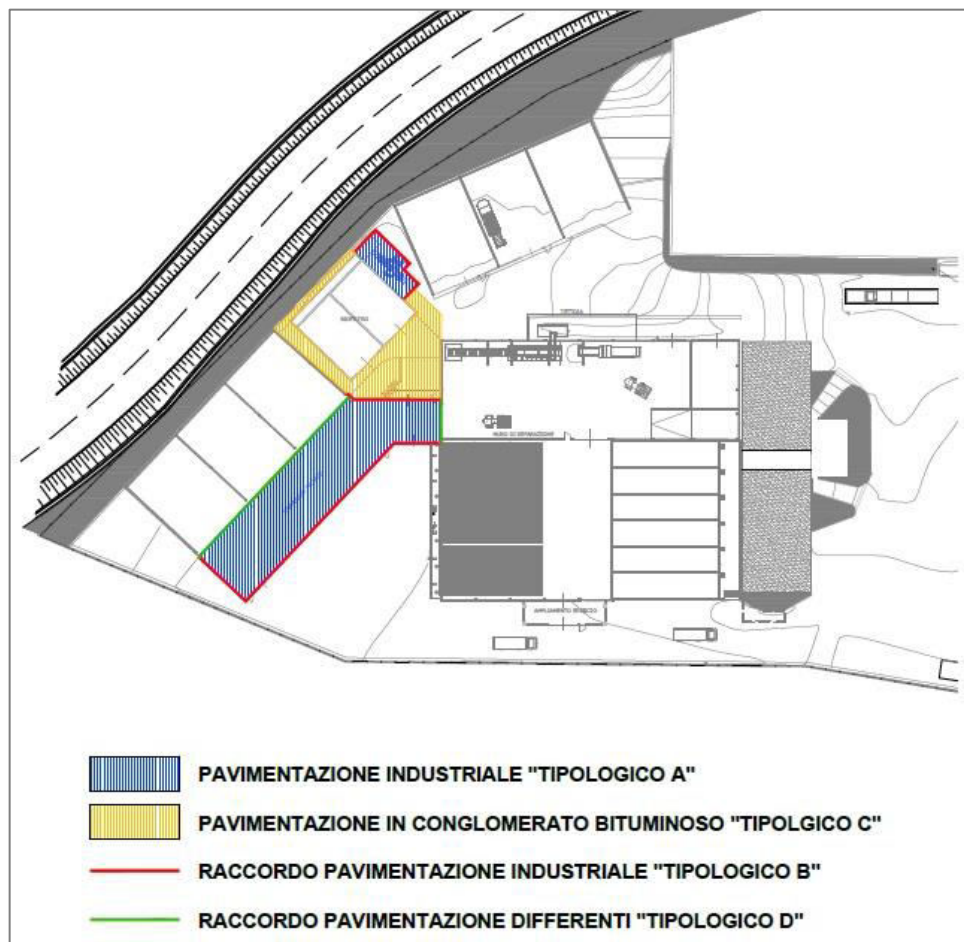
PLANIMETRIA GENERALE DI PROGETTO – Indicazione delle nuove pavimentazioni da realizzare
